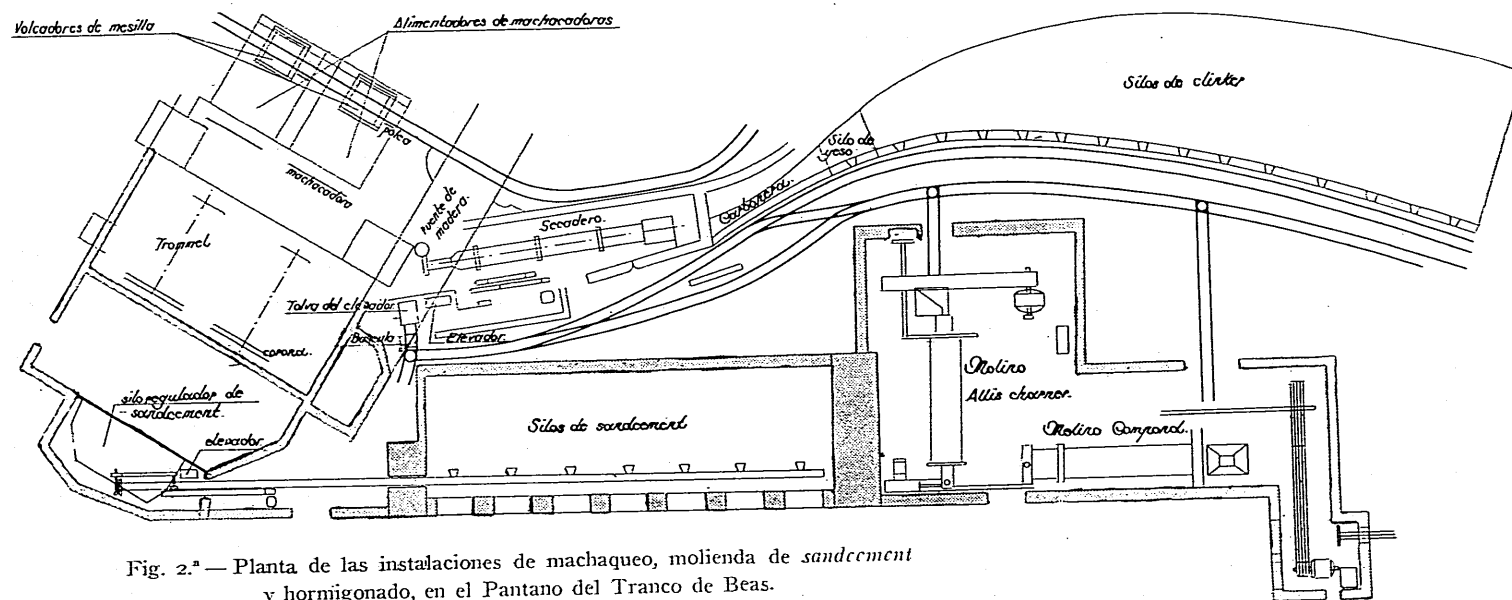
ª — Planta de las instalaciones de machaqueo, molienda de sandcement y hormigonado, en el Pantano del Tranco de Beas.
